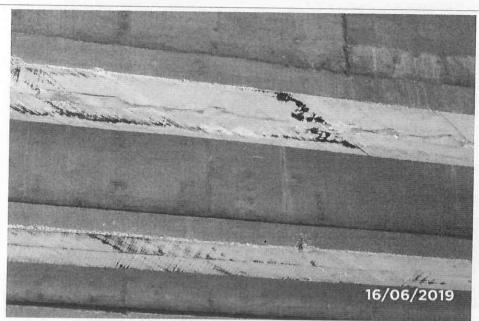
Detalhe das vigas com desplacamento de concreto, armaduras expostas e rompidas.
